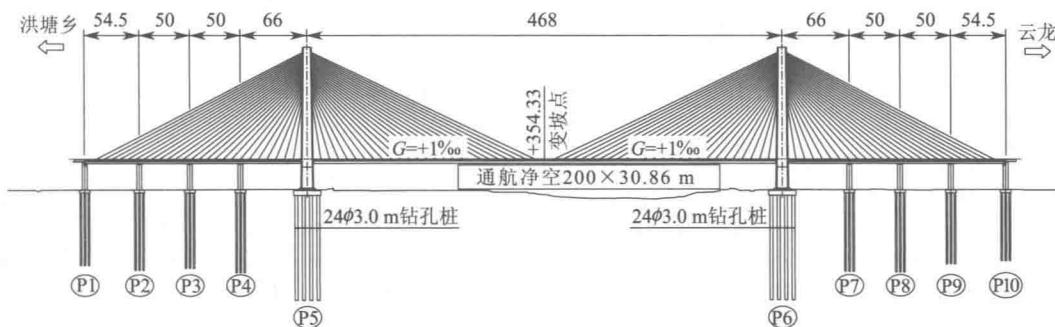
甬江桥特大桥立面图(单位:m)
